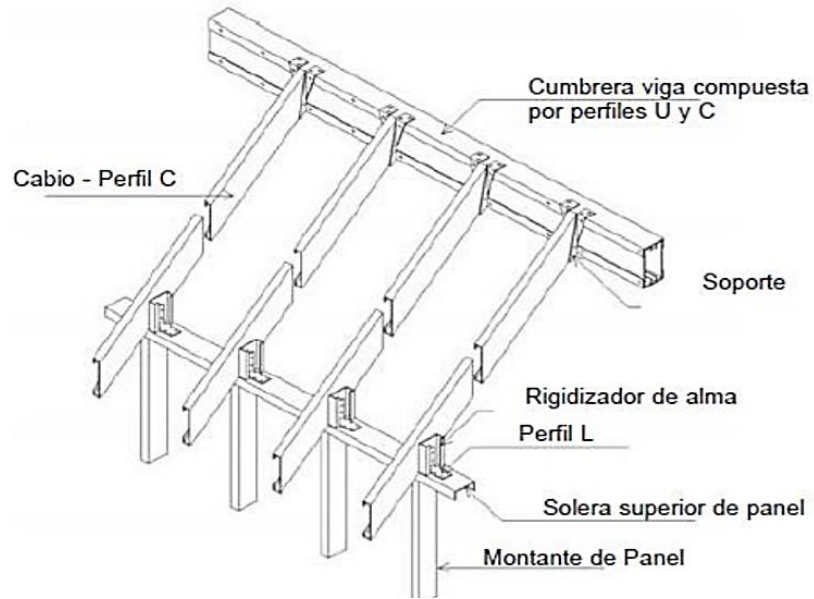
Detalle cubierta inclinada, Steel Frame
